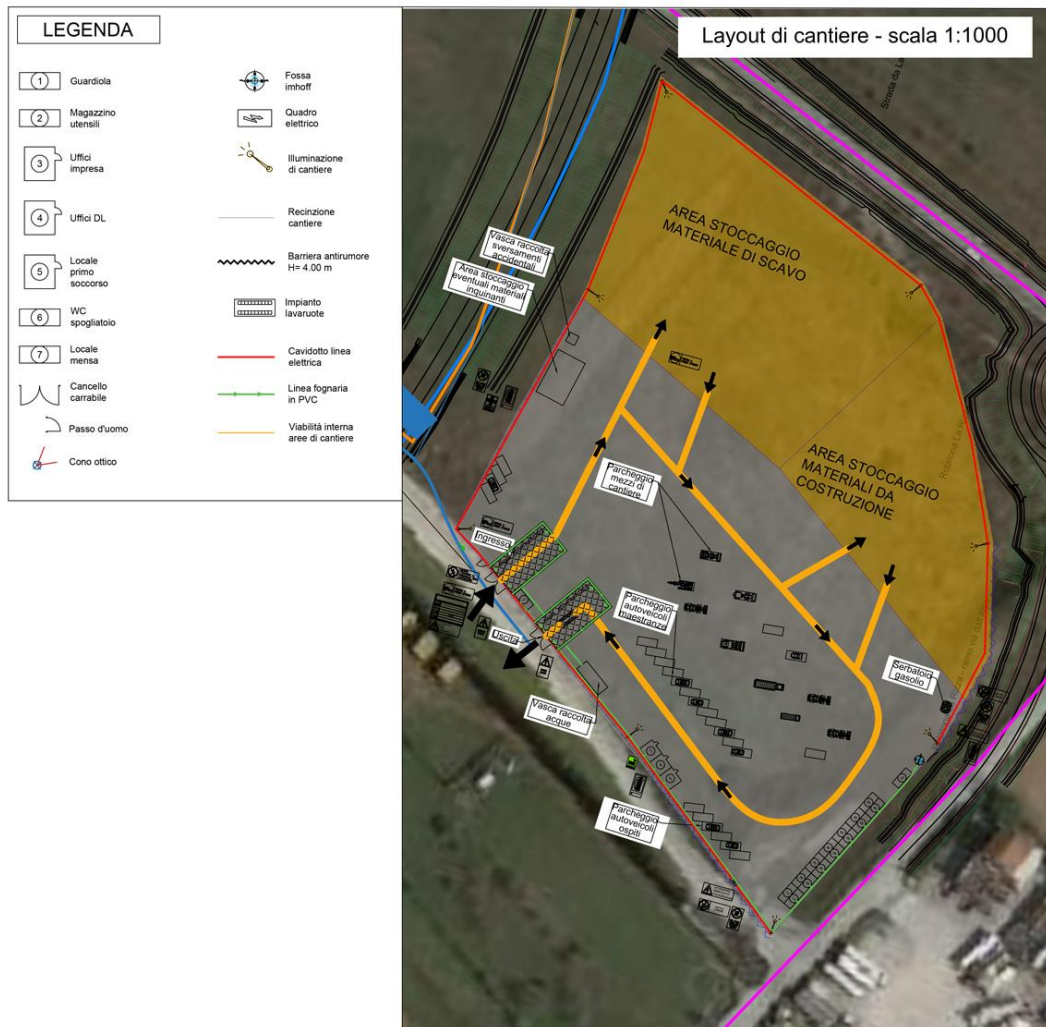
Stralcio planimetrico CB cantiere Base – AS1 Area di stoccaggio1
